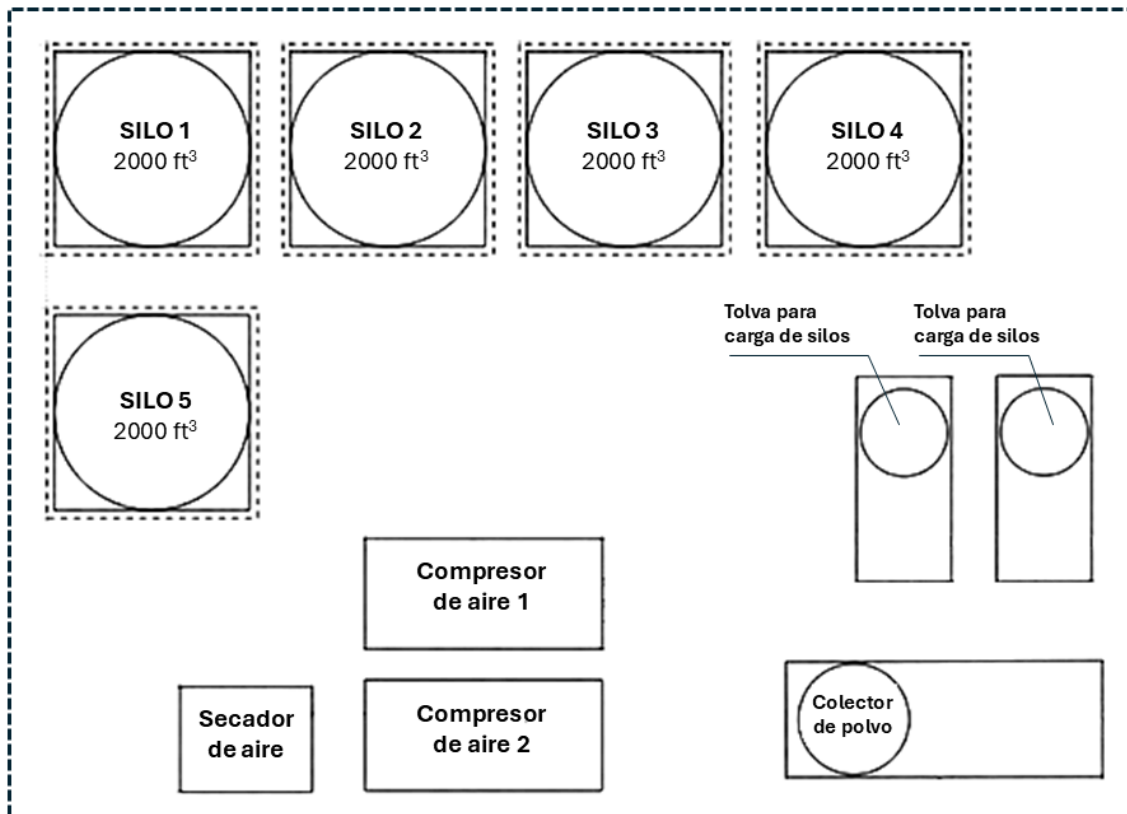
Diseño indicativo de infraestructura a granel de cemento (vista en planta).
